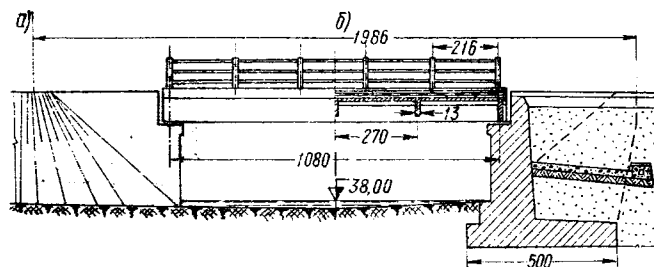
Общая схема моста с пролетными строениями ребристой конструкции из термозитобетона: а — фасад; б — продольный разрез
